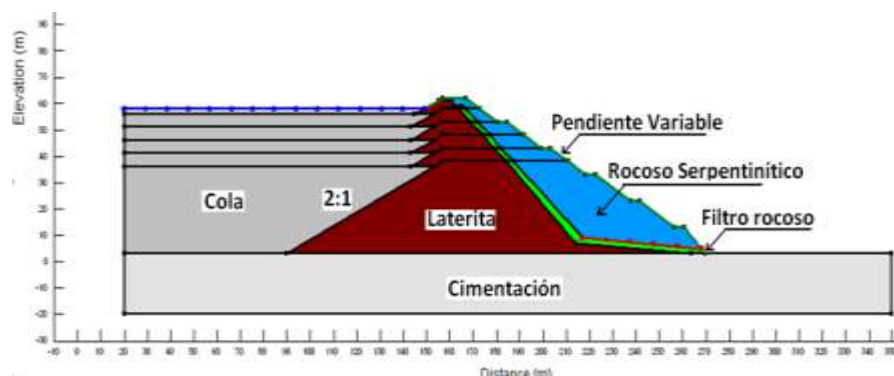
Sección transversal de la presa de cola Yagrumaje con el método de construcción línea central
